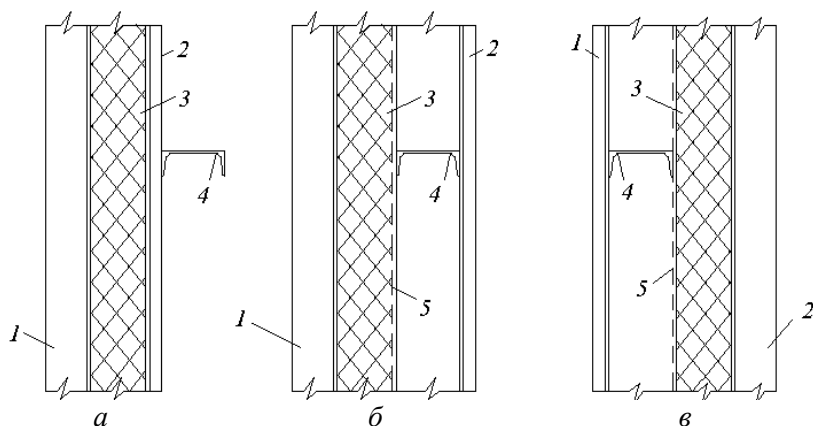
Конструкції утеплених стін із пошаровим монтажем:
